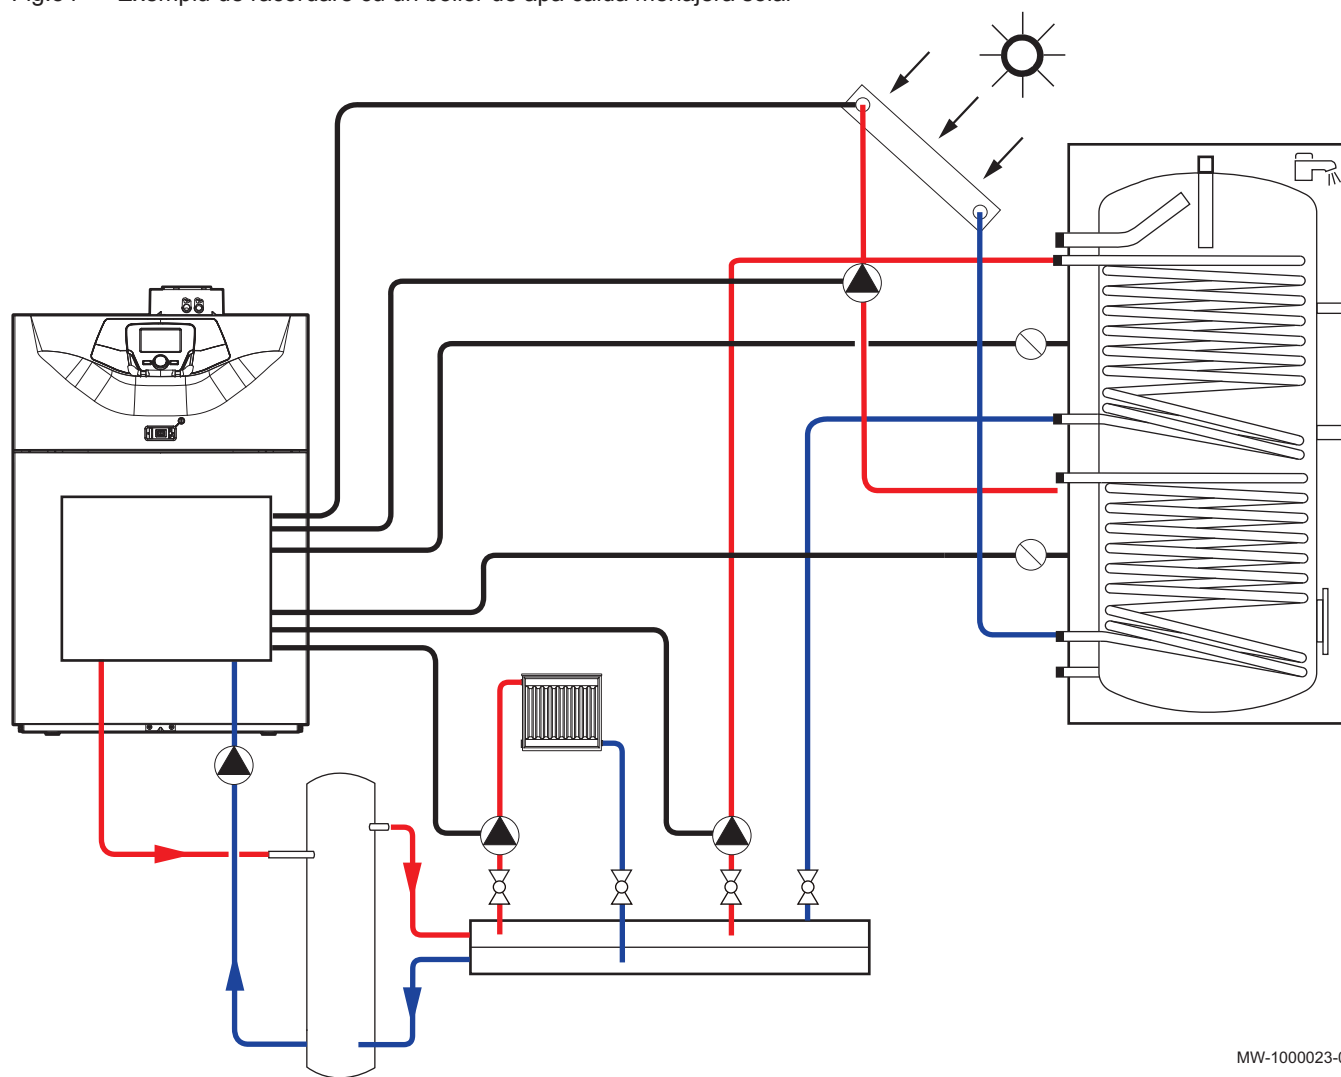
Exemplu de racordare cu un boiler de apă caldă menajeră
